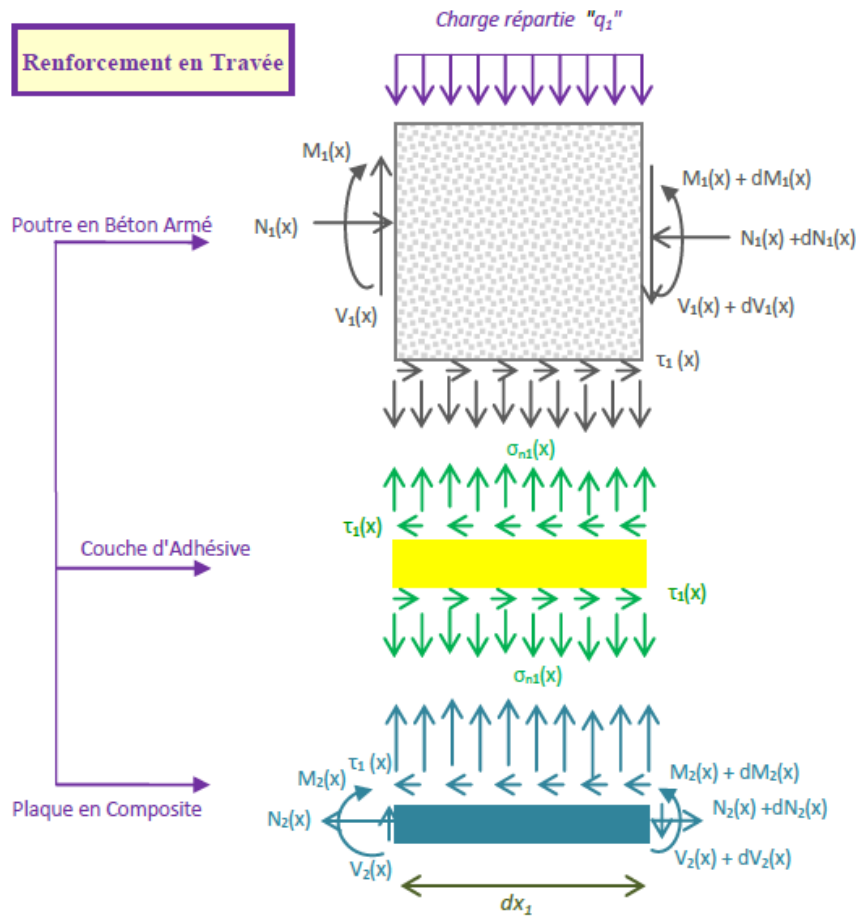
Forces dans un élément infinitésimal d'une poutre continue en béton armé renforcée par collage des plaques en composite: renforcement en travée.
